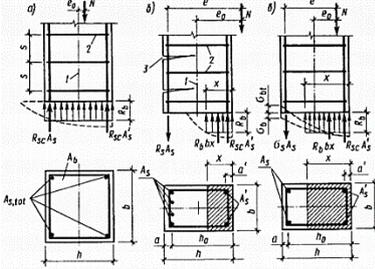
Схемы расчетных усилий в сечениях сжатых железобетонных элементов со случайными (а) и расчетными (б, в) эксцентриситетами
